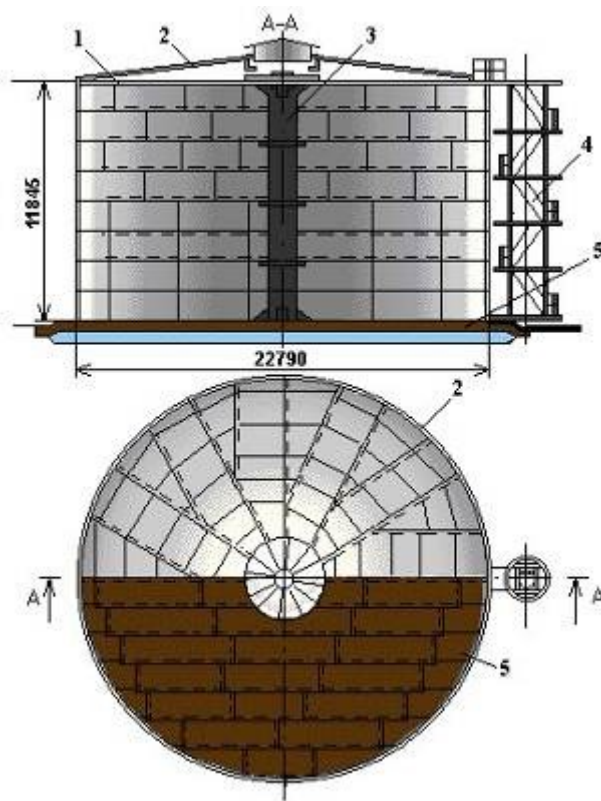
Резервуар вертикальный сварной: 1- рулонный корпус; 2- кровля; 3- опорная стойка; 4- маршевая лестница; 5- сварное днище.
